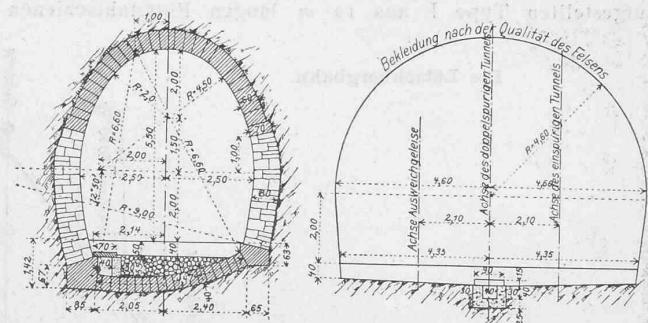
u. 7. Tunnelprofile zu Projekt I. — 1:200.
